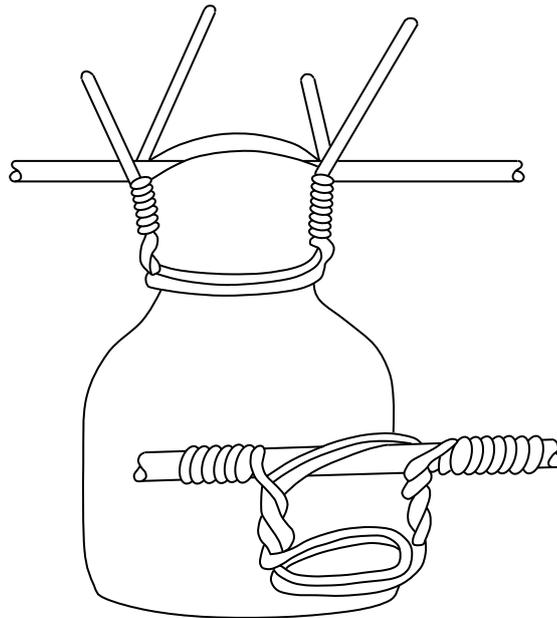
Крепление провода к изолятору на промежуточной опоре
